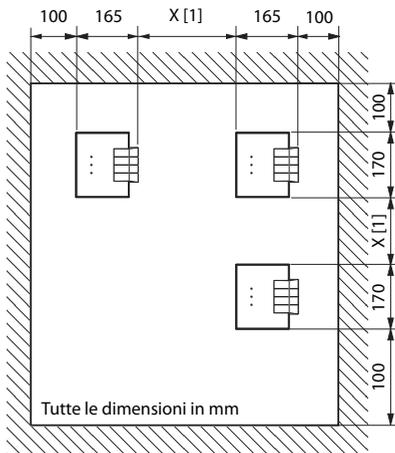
Disegno e quote per il montaggio a parete della staffa
